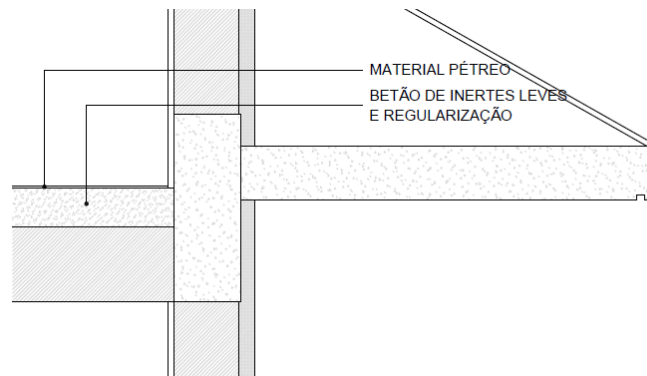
Pormenor construtivo do rés do chão (arquitectura)
